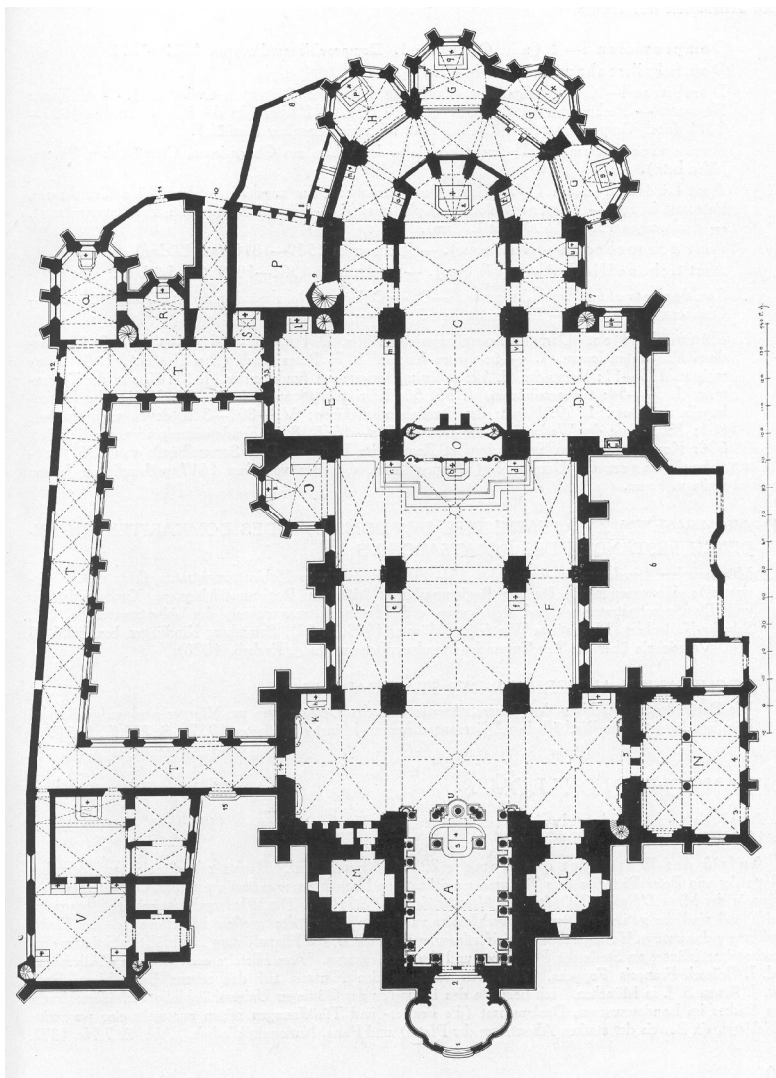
Grundriss des Domes zu Münster, vermutlich von van der Giese 1761, kopiert 1831.
